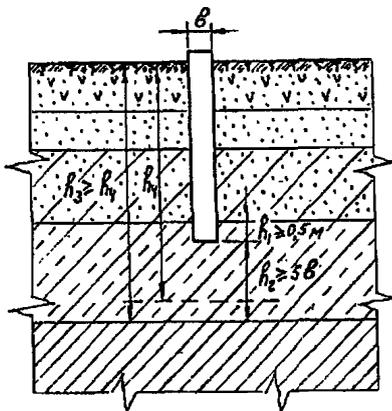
Расположение целевого фундамента относительно слоев грунта: d – толщина фундамента; h_1 – заглубление в несущий слой; h_2 – толщина слоя, на который опирается фундамент; h_3 – глубине заложения подошвы несущего слоя; h_4 – размер сжимаемой толщи
